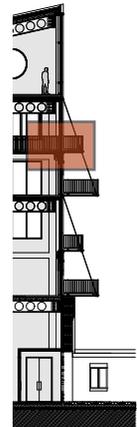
Balkondetail – Anschluss Regelgeschoss
